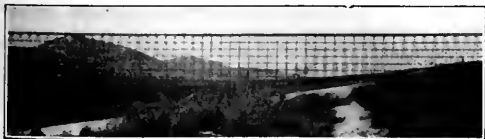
CANAL ELEVADO DE UNOS 48 KILÓMETROS DE LONGITUD, CUYA DURACIÓN SE PROLONGÓ 5 AÑOS MEDIANTE UN FORRO ADECUADO
